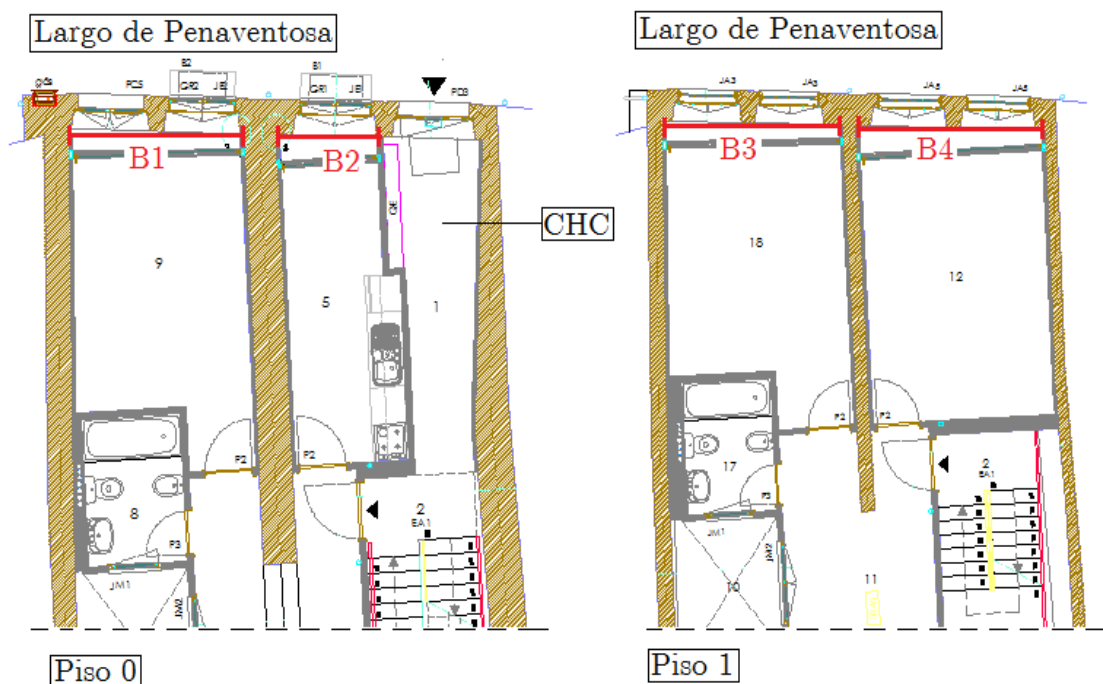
Comprimento da ligação de parede exterior do piso 1 com pavimento interior do piso 0 -
